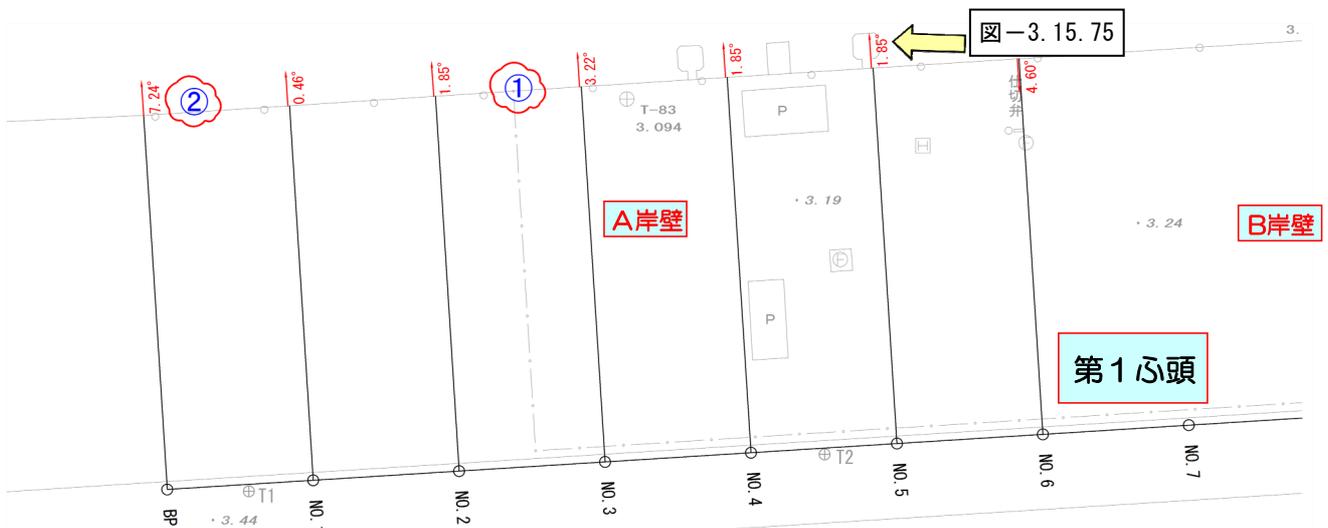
No.1 日立港区_第1ふ頭地区 A 岸壁の平面図および計測位置
